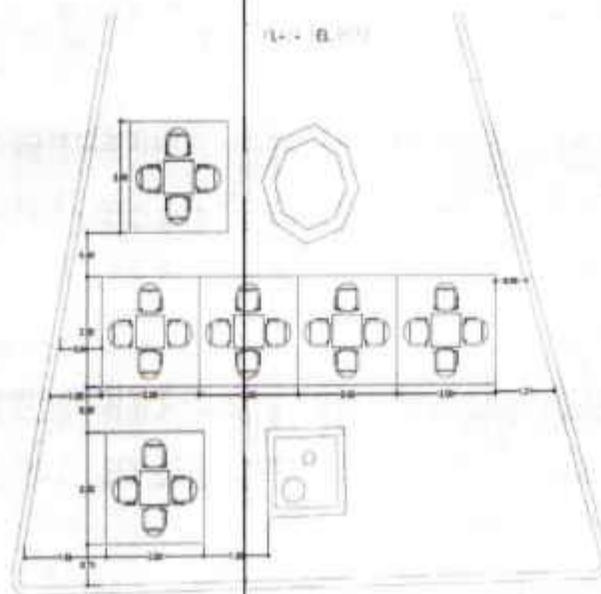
Plano RESTAURANTE BONCHE GASTRO BAR - Distribución de mobiliario.
